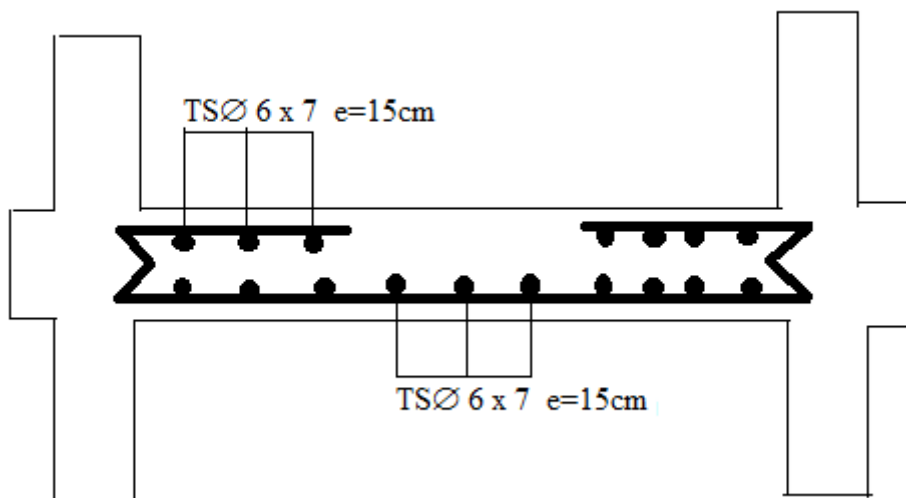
Schéma du ferrailage de la dalle plancher étage courant.
